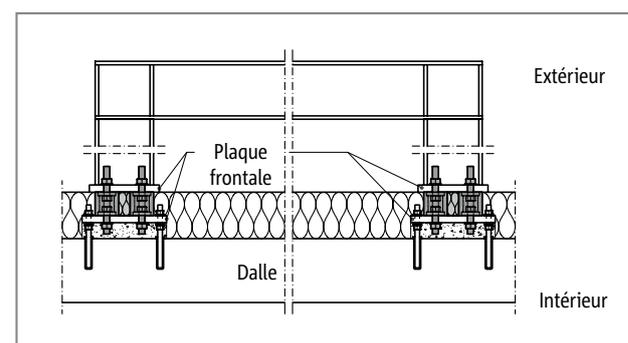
Schöck Isokorb® T type S-V : assemblage de cadre rigide pour structures secondaires (les moments supplémentaires dus aux imperfections doivent être pris en compte)
